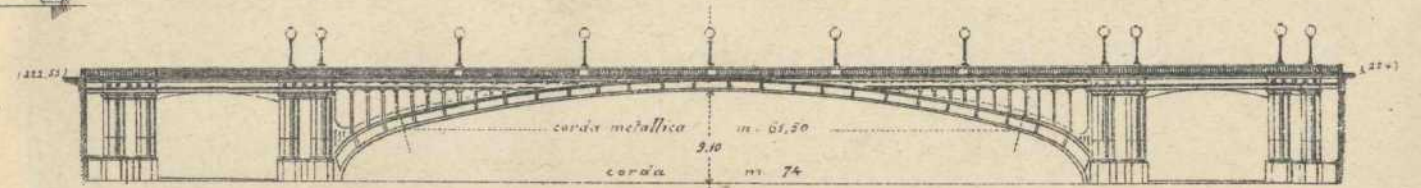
Progetto di ponte di struttura mista dell'Ing. Ghiotti.
